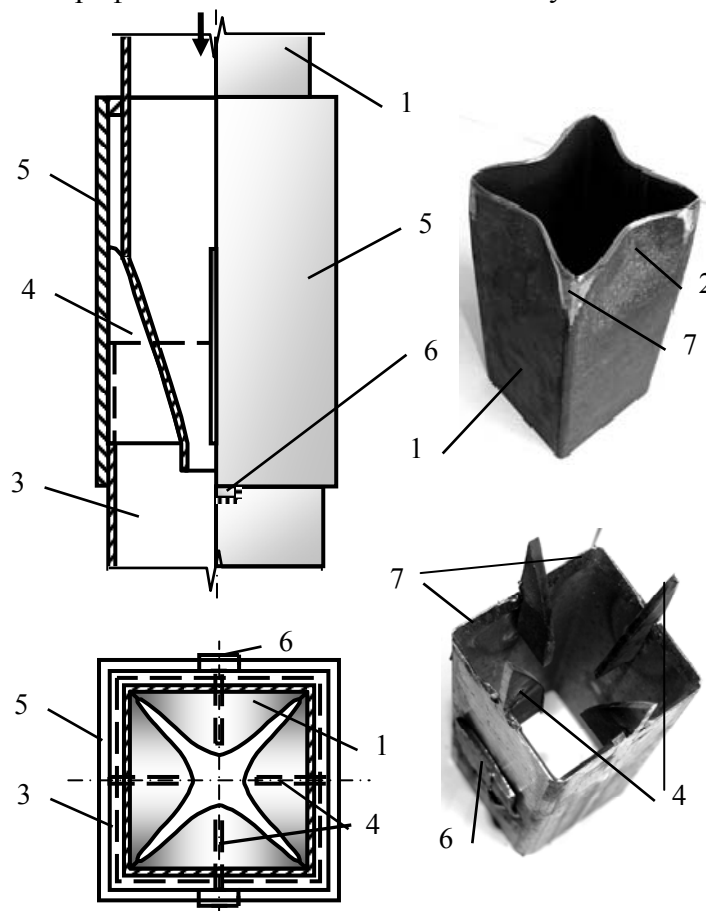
Узел податливости с крестообразно деформированными стенками несущего профиля
